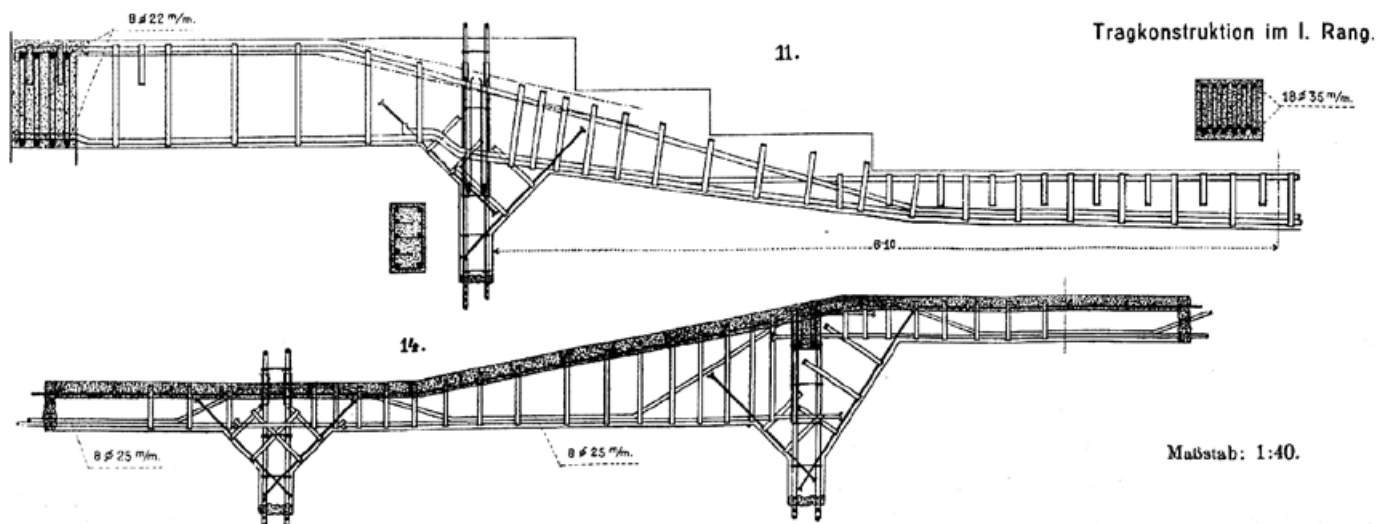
Details der Bewehrungsführung (Beton & Eisen 1904, Ausschnitt aus Tafel XI).
